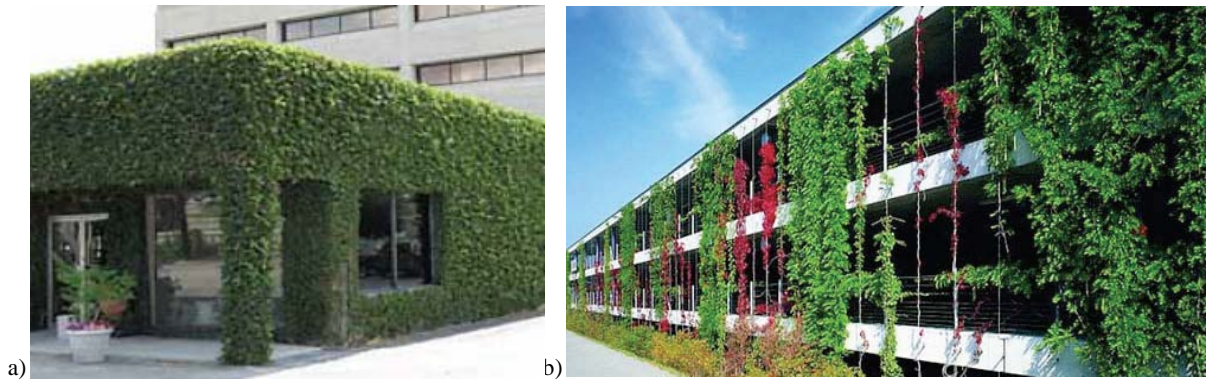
2 exemplos de fachada verde: a) através de painel modular (Retirado de: Mir, 2011); b) através de sistema de cabos (Retirado de: GreenRoofs, 2008)
